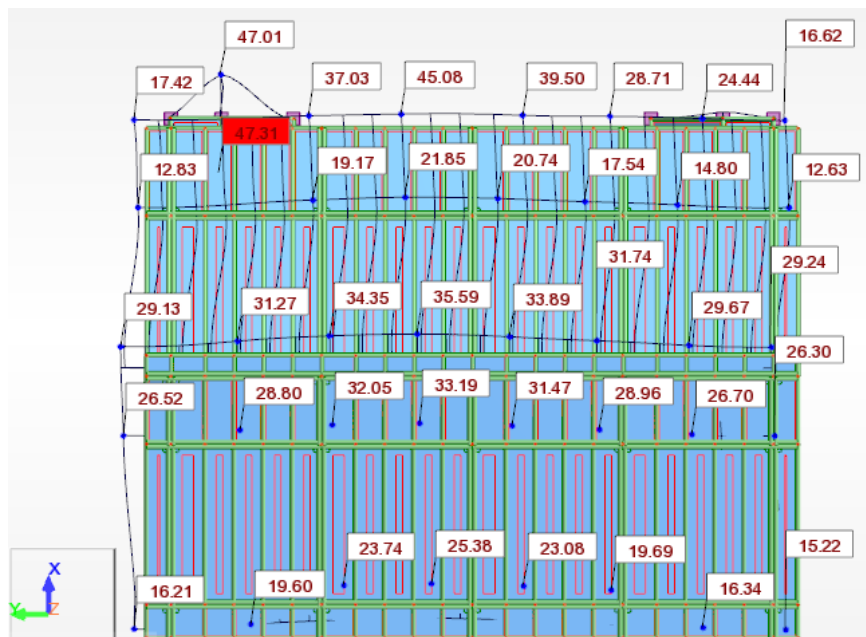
Desplazamientos nodales en planta (Análisis modal – CQC). Vista en planta, Nv.+7.54m.
